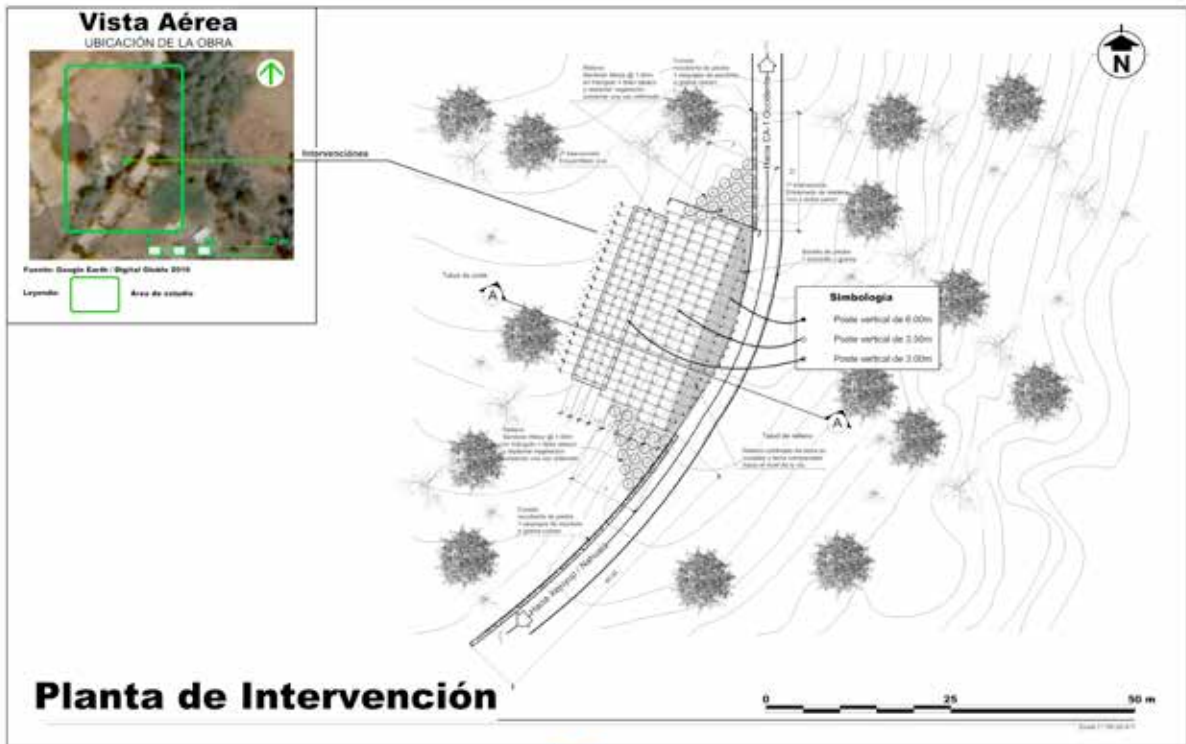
Planta de intervención. Planificación Obra ORCC-06/RD-SOL-10.
